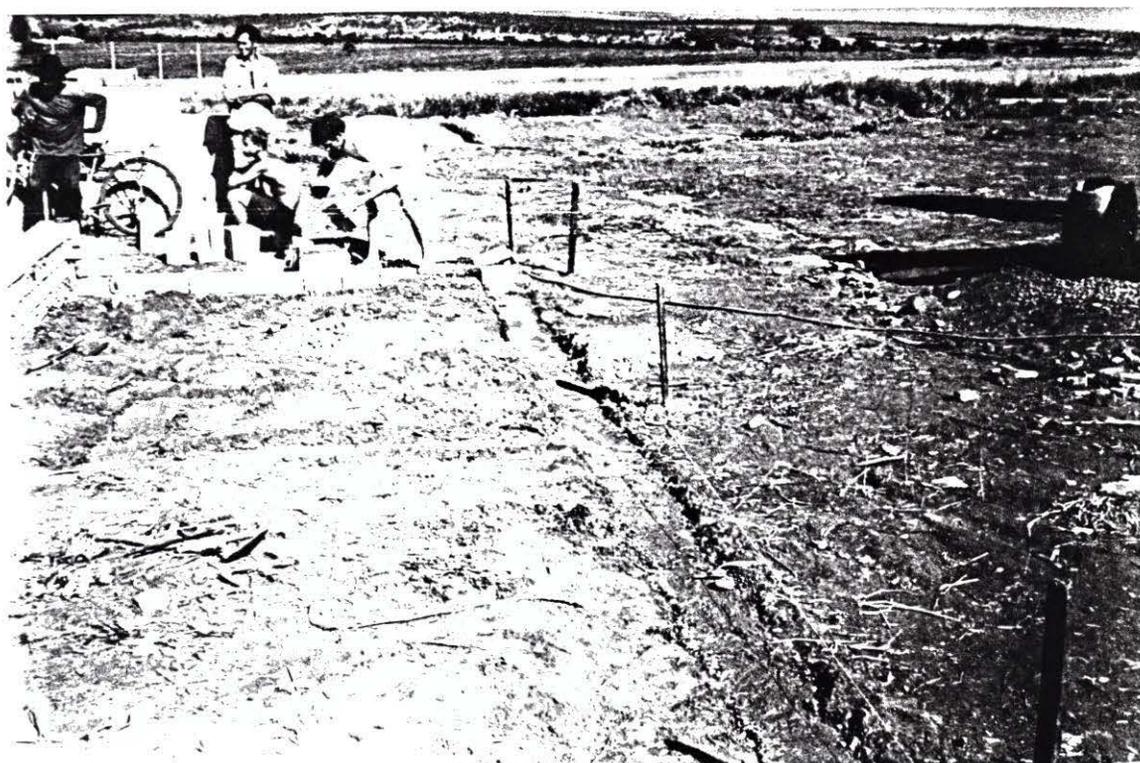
Início de construção em terrenos adquiridos através do FUMHAP - 1995 (autoconstrução)
